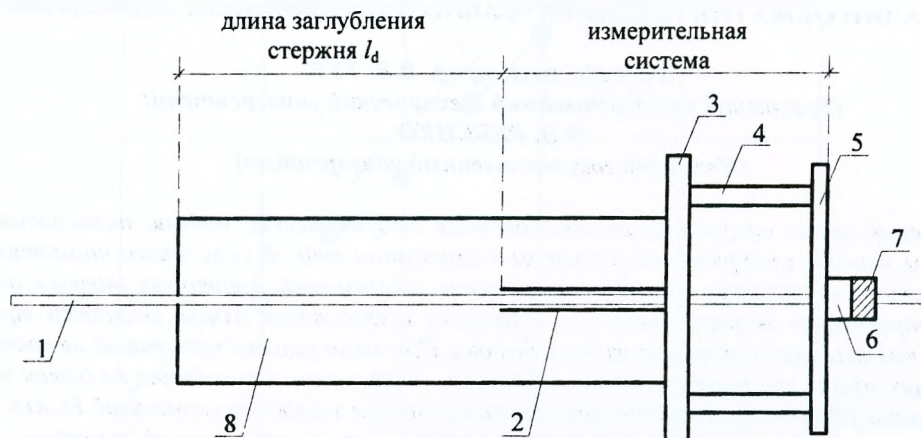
Схема конструкции испытательной установки для определения длины анкеровки по методике ECADA [2]:
